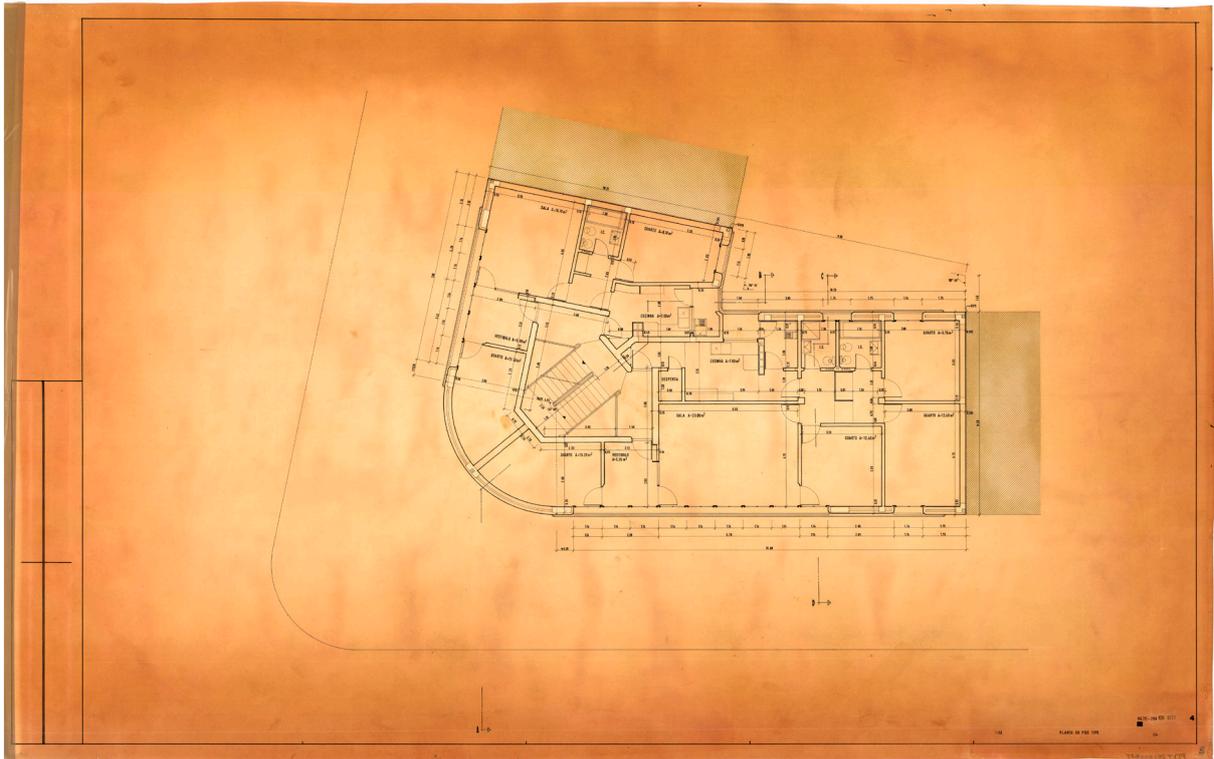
Projeto: gaveto nascente da Rua Alberto de Oliveira – Rua António Patricio CRE 126 C, planta do piso tipo
